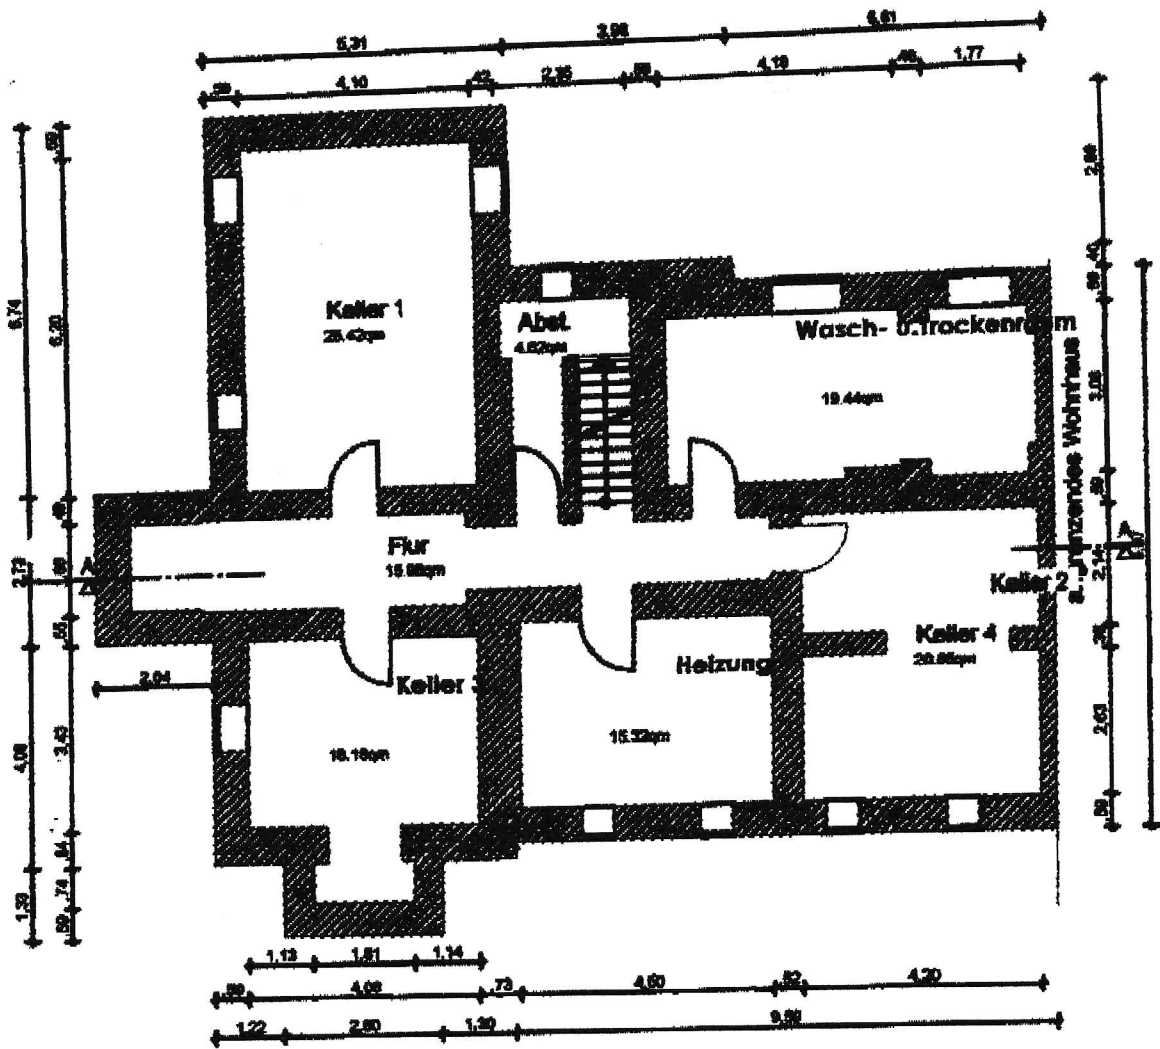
Grundriss Kellergeschoß, Hostatostrasse 26, 65929 Frankfurt am Main
